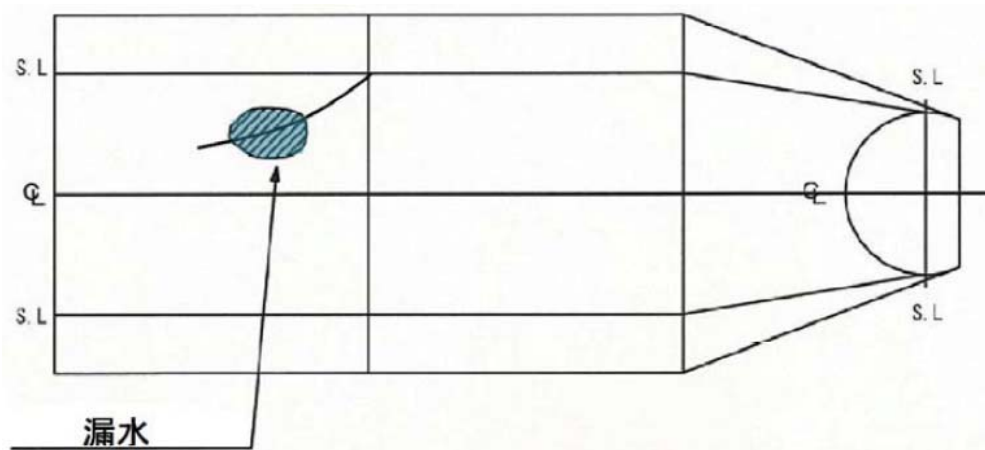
。9 ひび割れからの漏水位置の例
